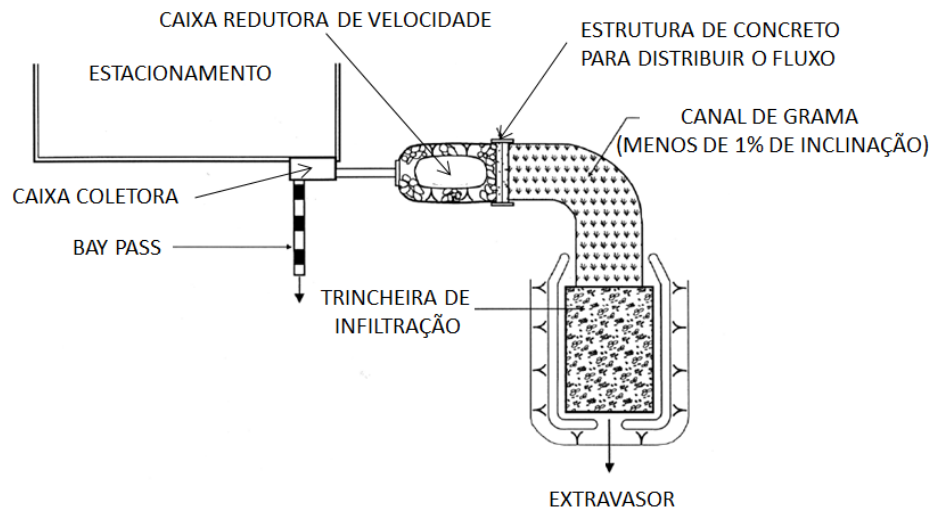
Exemplo de trincheira de infiltração com pré-tratamento - PLANTA
